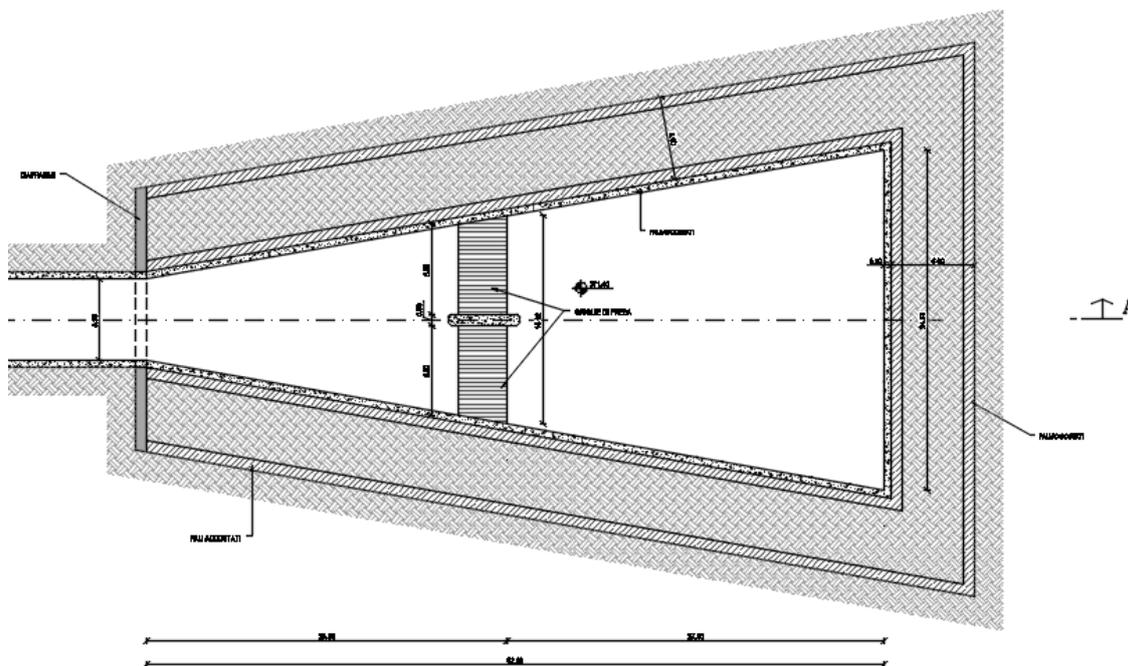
Vista planimetrica dell'opera di presa di valle (sezione A-A)
